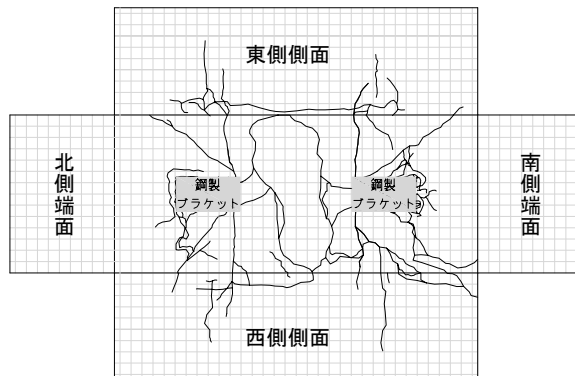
ひび割れ損傷図 (最終損傷状況)
